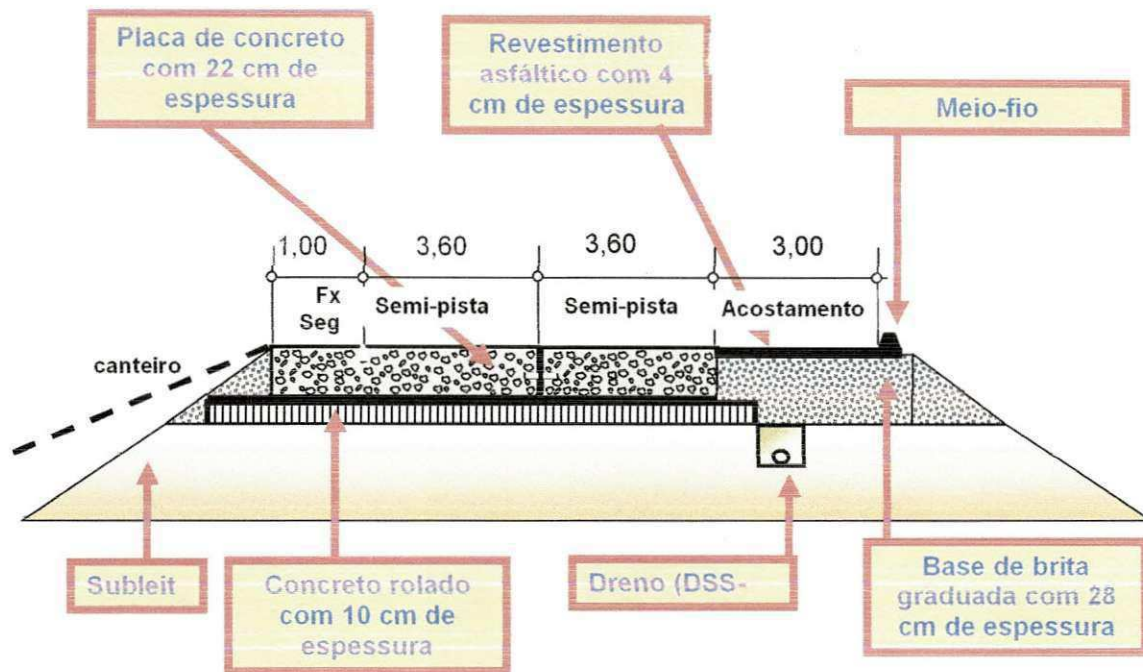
Seção Transversal Tipo – Pavimento de Concreto
